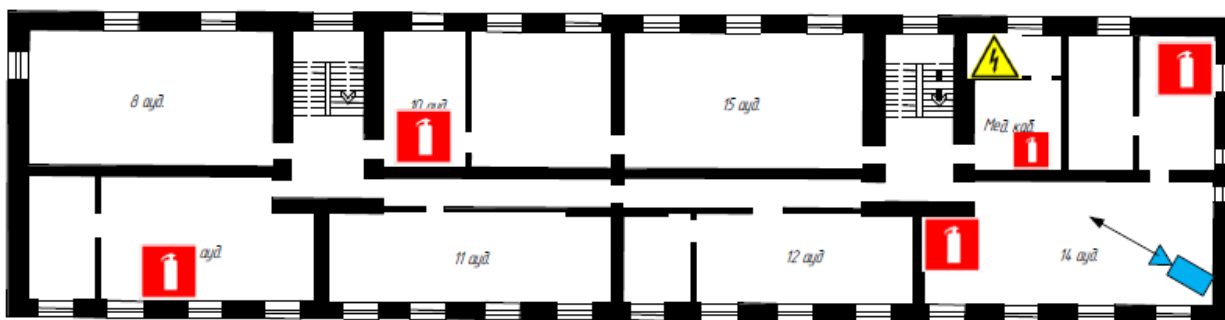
2 этаж второго корпуса ЮТИ ТПУ
